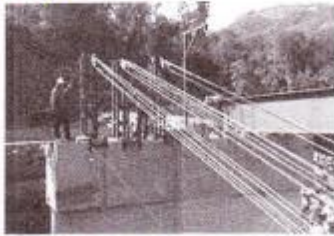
El rodillo debajo de la viga principal y la instalación de la viga principal
